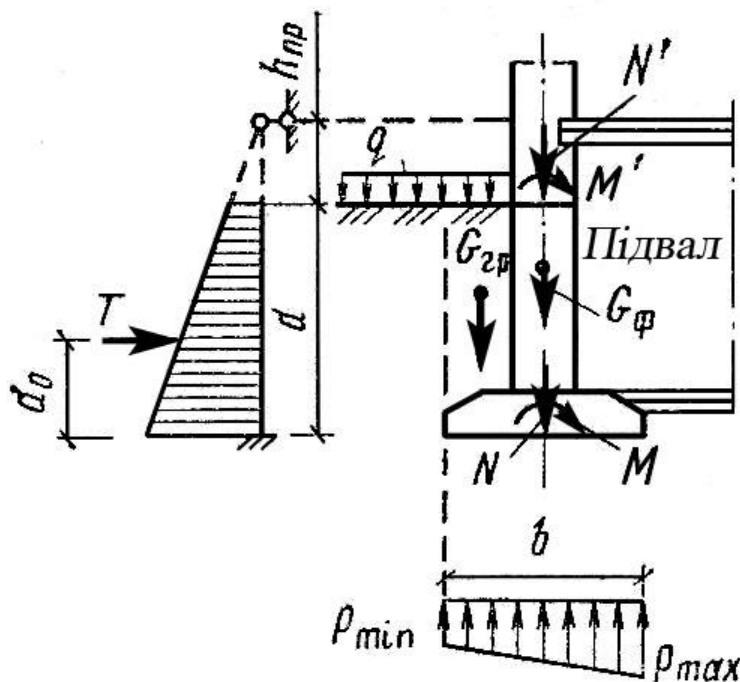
Розрахункова схема позациентрово навантаженого фундаменту
